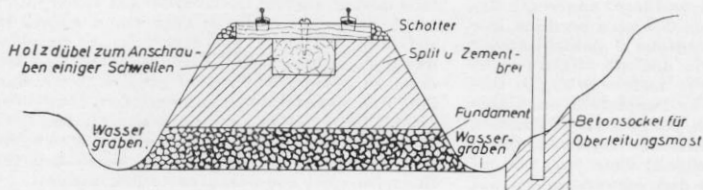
Querschnitt durch den Damm. Das Fundament besteht aus zerkleinerten Backsteinen. Die Holzdübel sind — im Gegensatz zu Abb. 5 — hier gleich mit einbetoniert.
